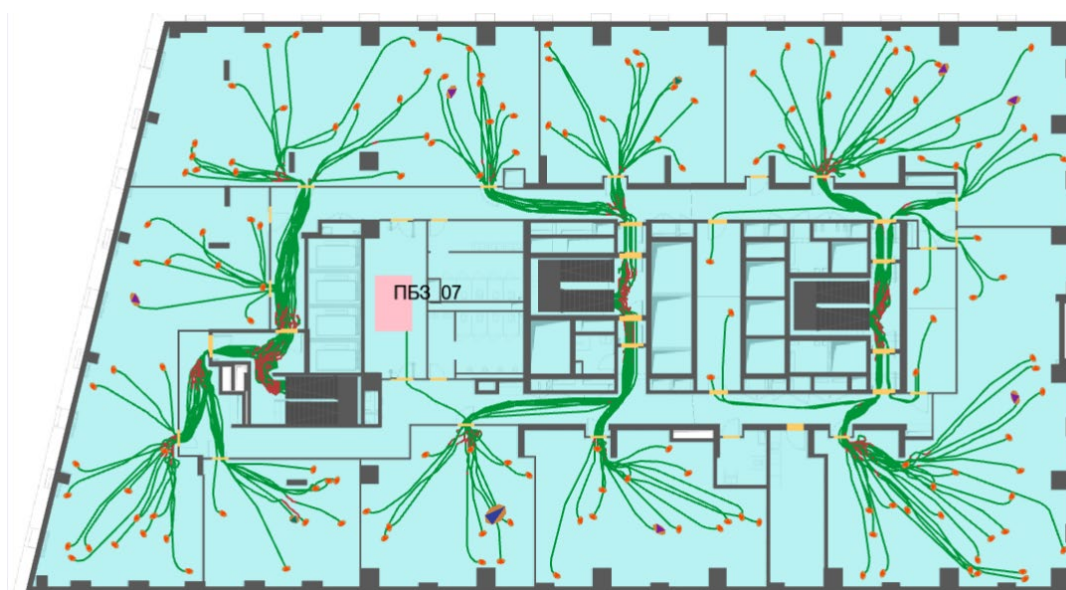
План 7-го этажа и нанесенная на него расчетная (принципиальная) схема эвакуации
